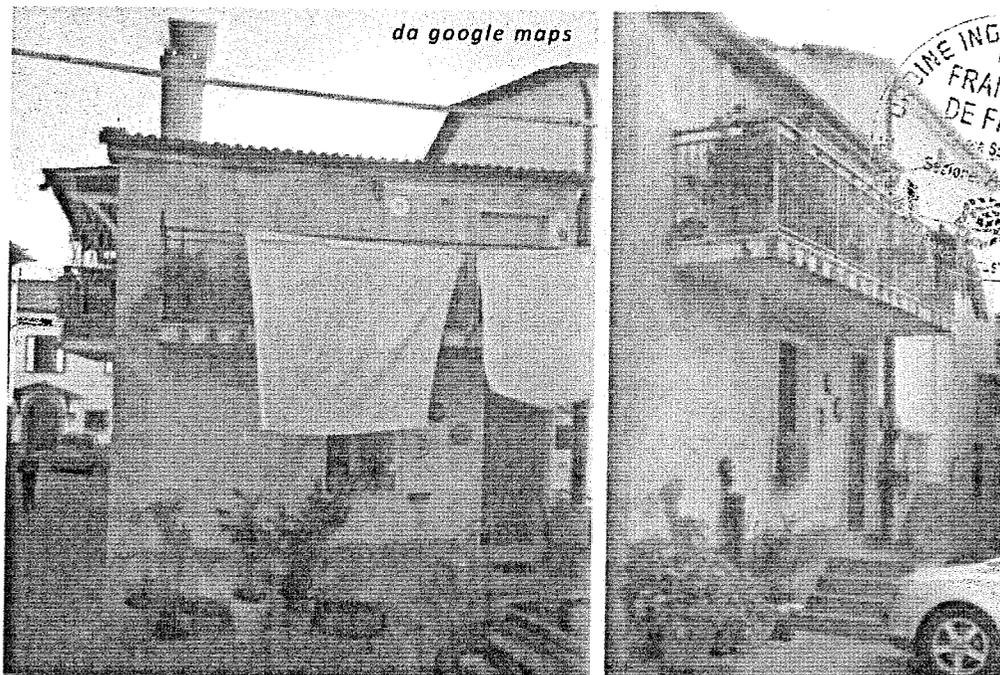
Ingresso lato sud da Piazza Michele Bianchi. Il piano terra da questo lato è leggermente interrato per cui il piano primo soprastante è facilmente raggiungibile con poche alzate di scala.
